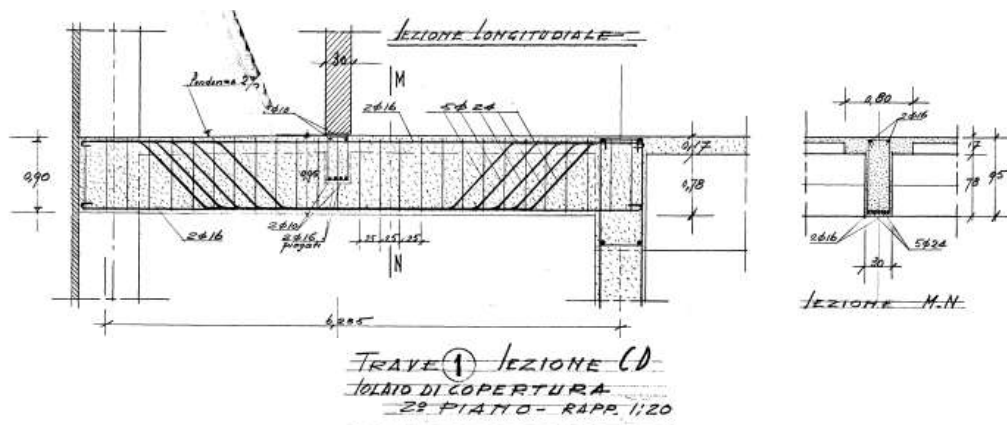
Dettaglio della disposizione dei ferri nelle travi 1 del piano terzo, stralcio del progetto preliminare.
